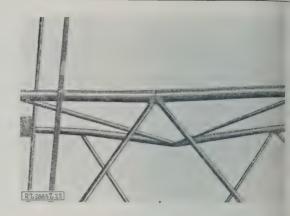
zeigt die ausgeknickten Druckstiele des schweißten Rohrmastes nach der Zerstörung. Auch sieht man, daß die Rohrwand eingedrückt ist, ohne die Schweißverbindung der Schrägen sich gelöst hat
